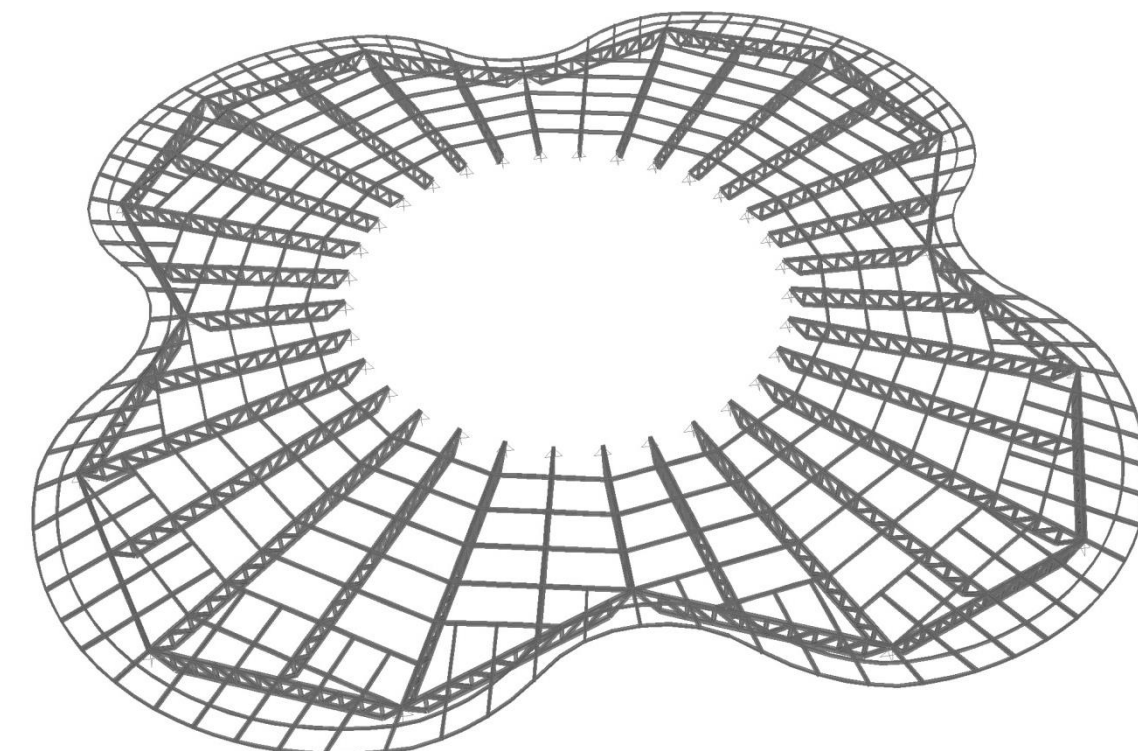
Modelización 3D estructural del forjado sin losa de la planta tipo 1
